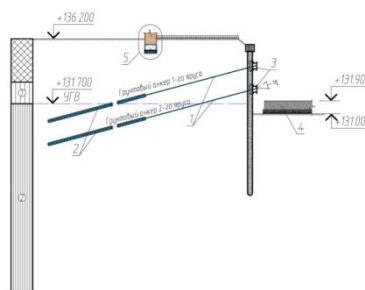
Характерный разрез ограждения котлована: 1, 2 - грунтовые анкера ЭРТ первого и второго уровней; 3 - стальные анкерные пояса; 4 - монолитный плитный железобетонный фундамент строящегося 6 этажного объекта; 5 - фундамент одного из зданий существующей застройки
